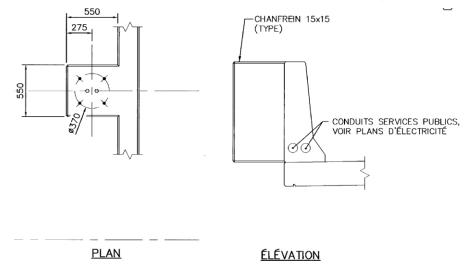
Vue en plan base de lampadaire et coupe de la glissière de béton sur le pont, extrait des plans tel que construit de DESSAU 2001-02-26
